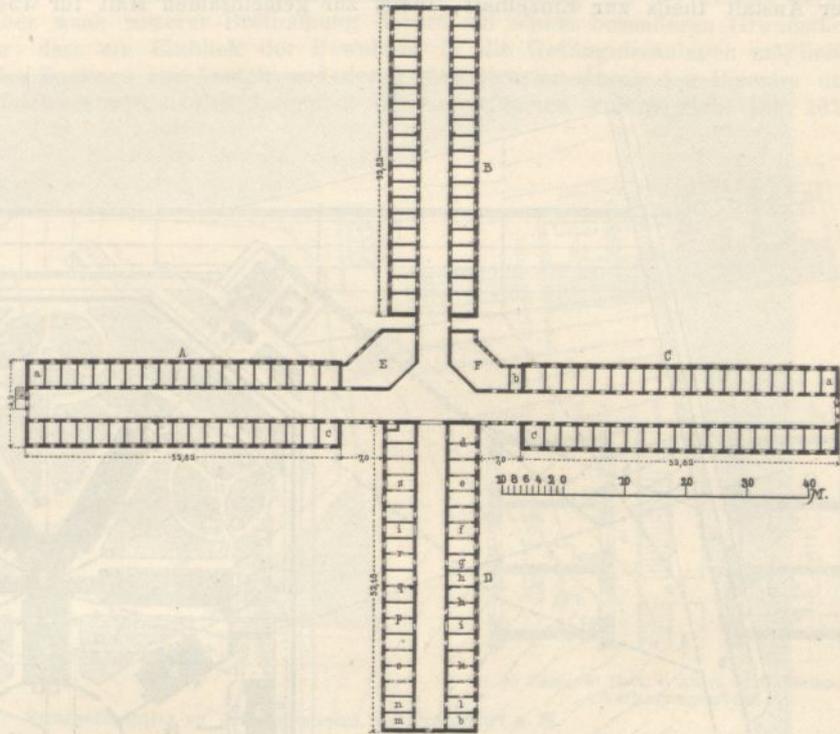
Erdgeschoss-Grundriss vom Hauptgebäude der Strafanstalt in Herford (Architekt Schuster).
